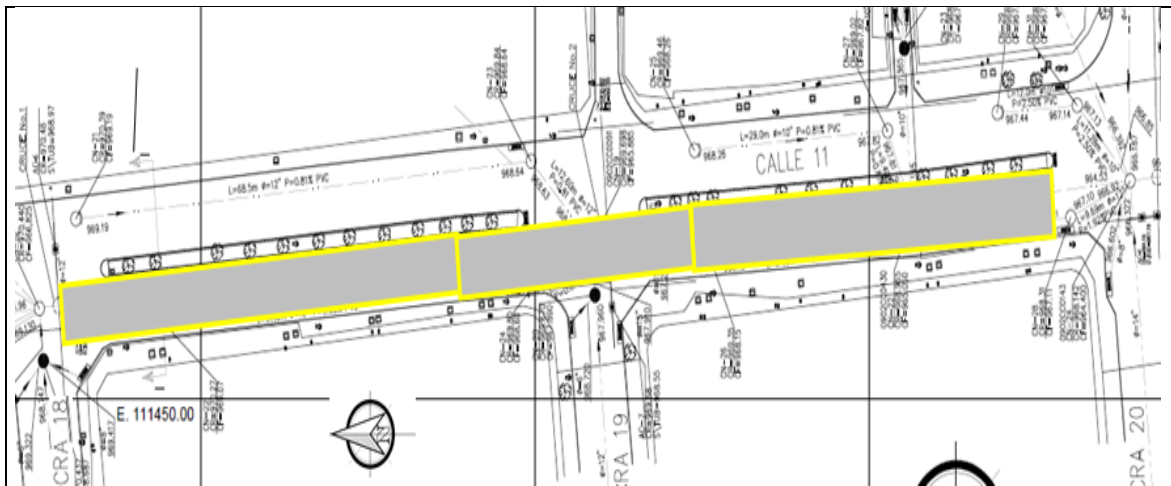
Pavimento de la calle 11 entre carrera 20 y 18.
